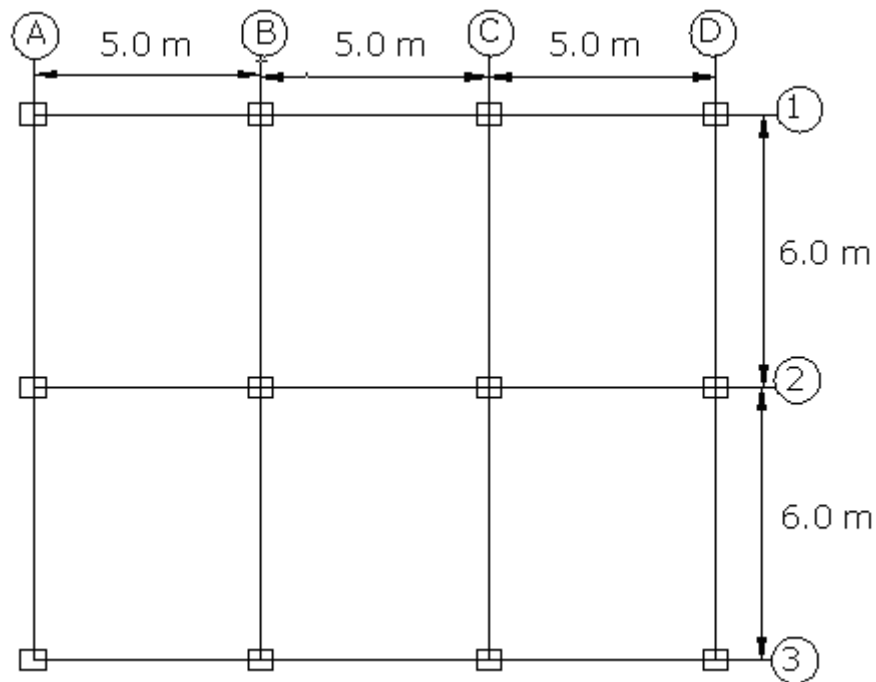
Vista en planta de las estructuras de 2, 4 y 6 pisos
